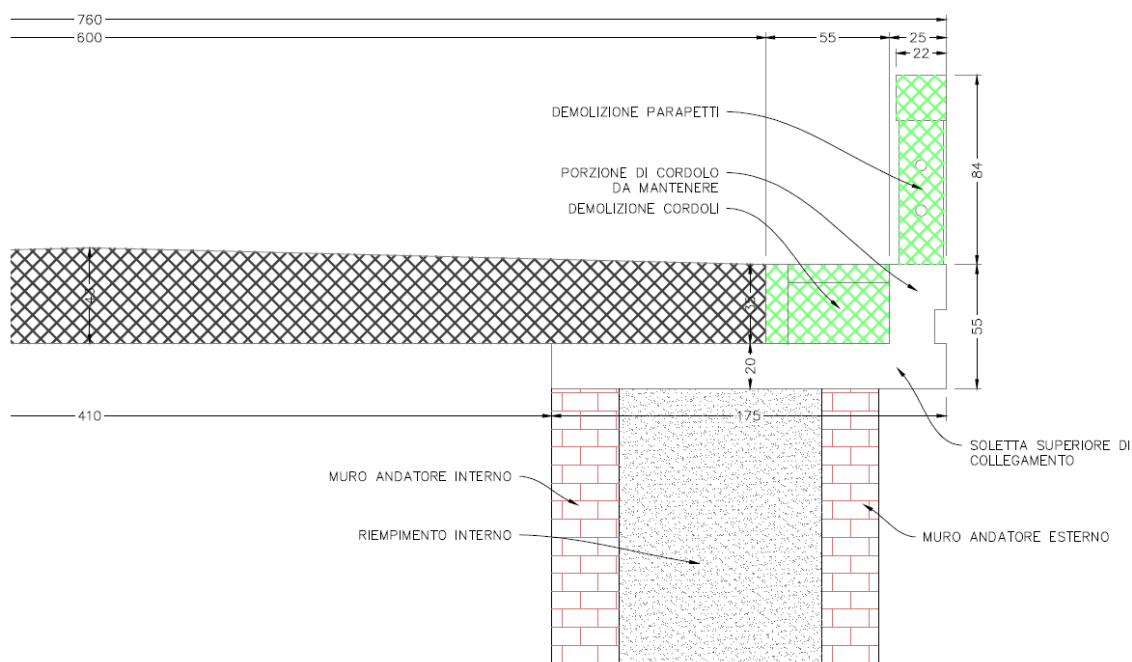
Stratigrafia del muro andatore della spalla
